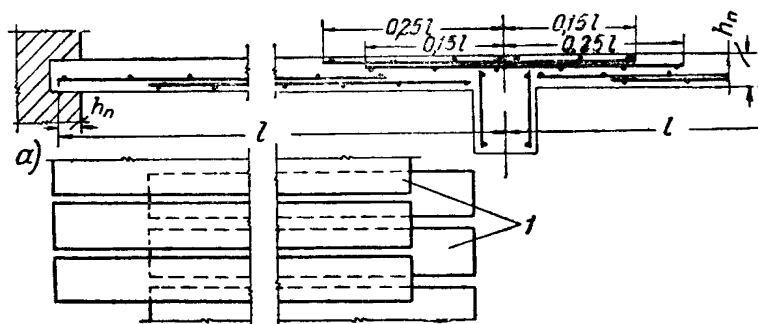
Армирование балочных плит двойными сварными сетками с взаимной раздвижкой
